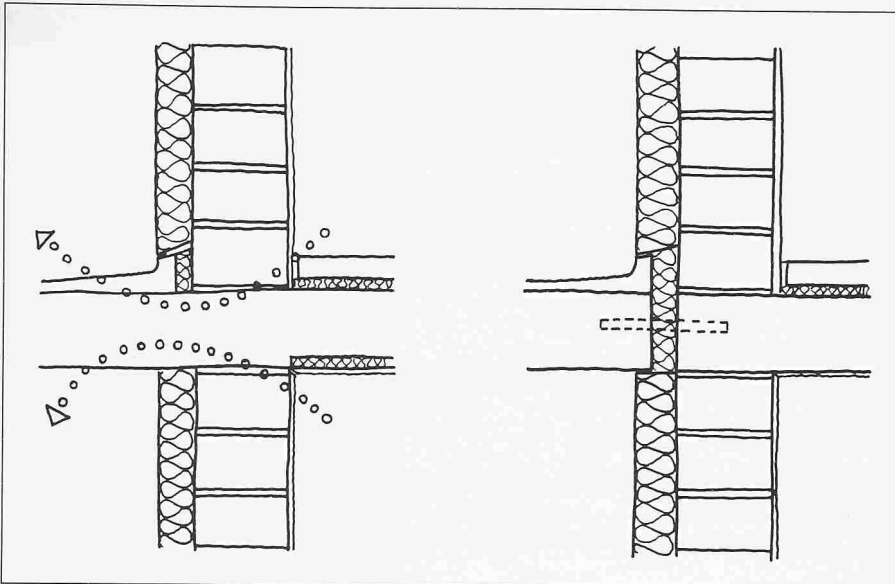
Aussenwand mit Aussendämmung/Balkon.
